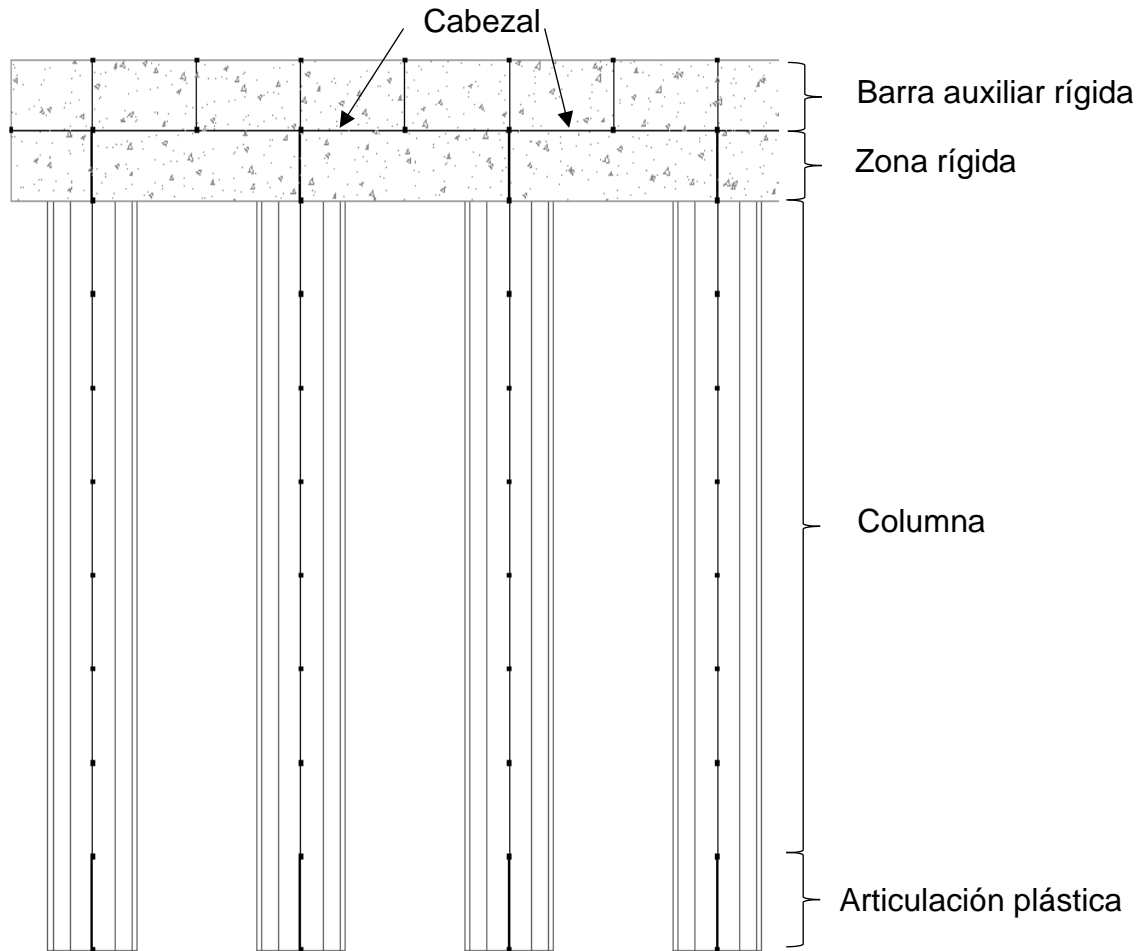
Esquema de modelado de la pila con 8 metros de altura
